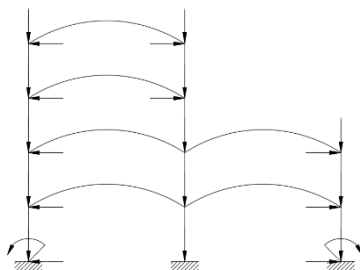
Схема усилий в вертикальных конструкциях сооружения с перекрытиями-оболочками
